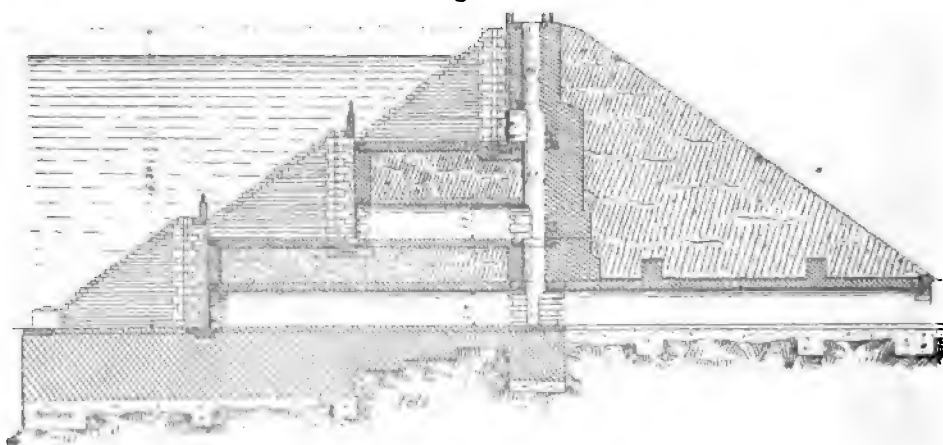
11e. Anordnung des Staudammes des Liez-Reservoirs. Fig. 10 zeigt den Grundriss, Fig. 11 den Aufriss und Fig. 11a den Querschnitt
